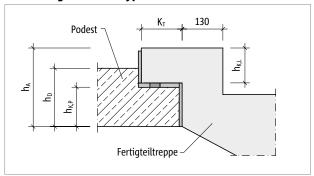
Schöck Tronsole® Typ BZ: Bemessung
